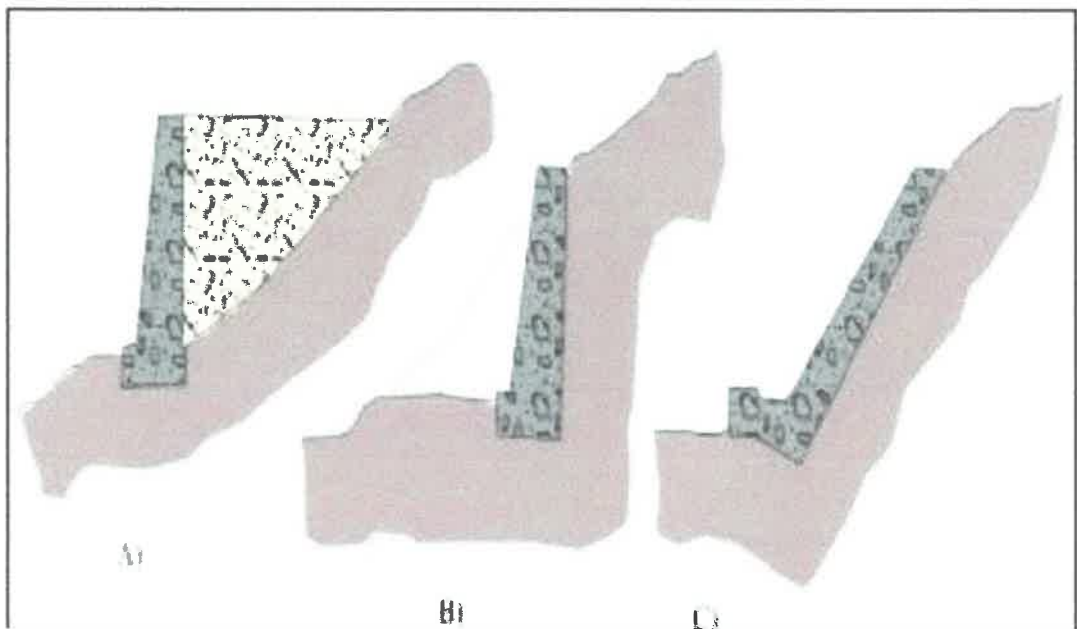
a) muro de sostenimiento b) muro de contención c) muro de revestimiento, fuente: INGEMMET, 2020.
